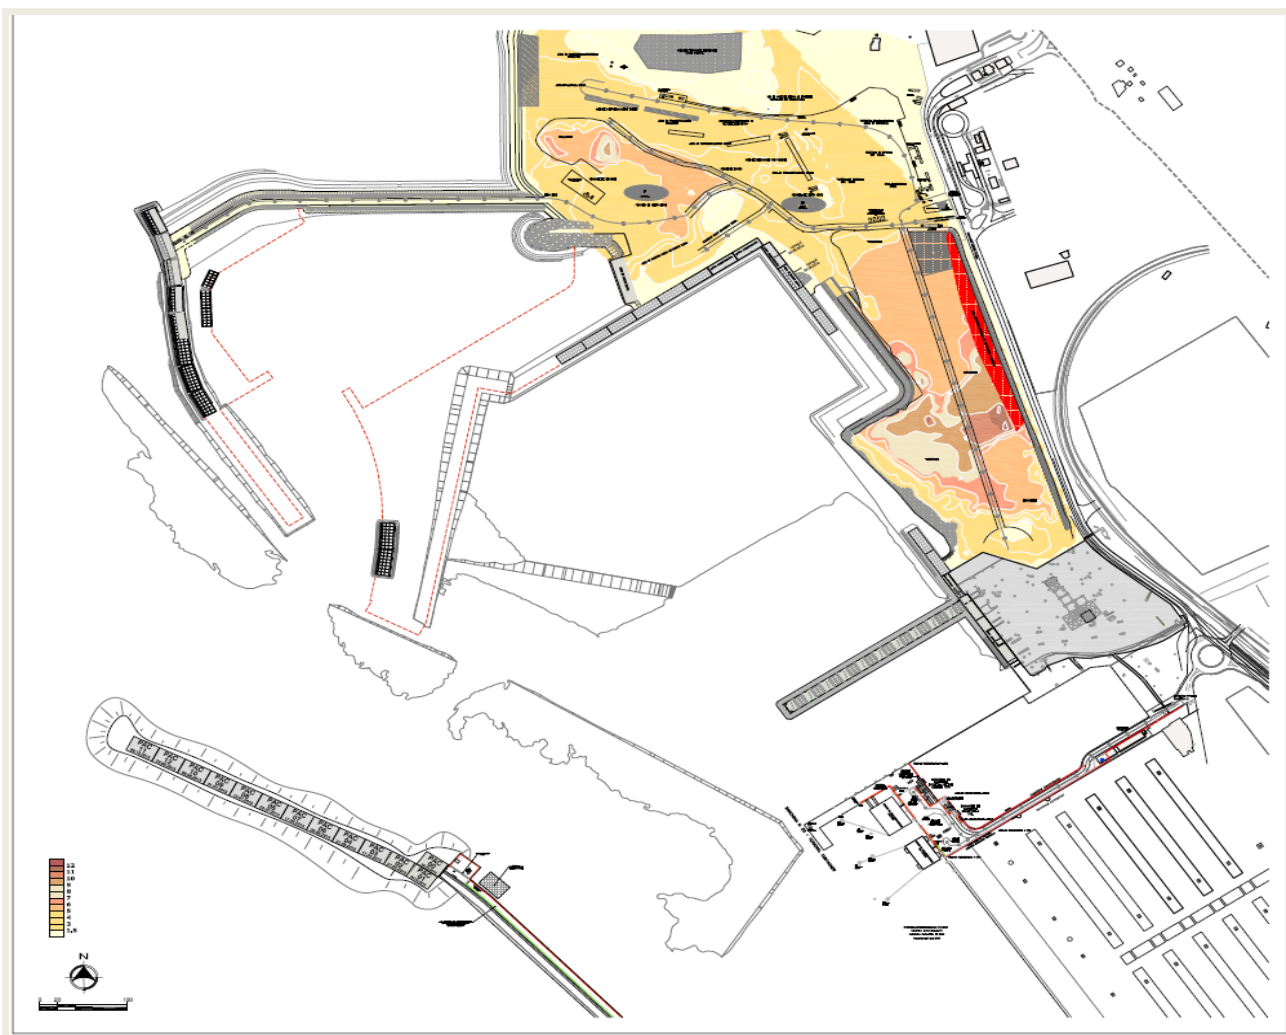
Porto di Civitavecchia -Opere Strategiche - Planimetria della situazione attuale
